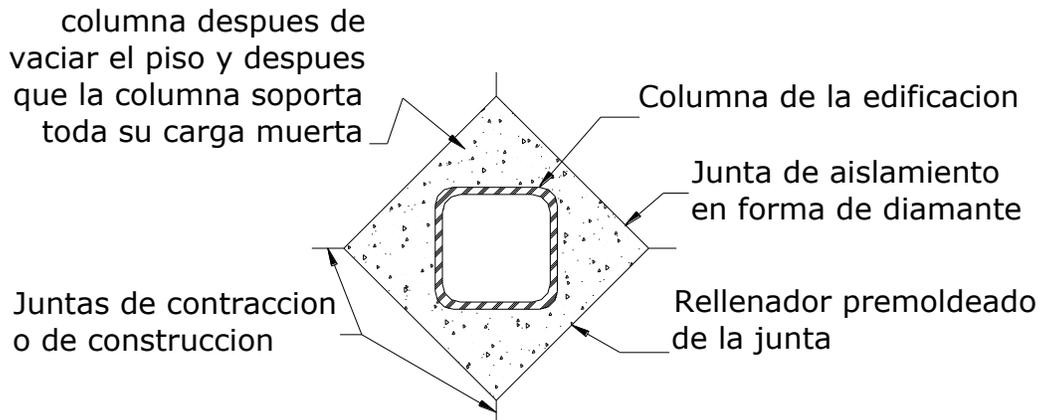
b - Junta de aislamiento en columnas (vista de planta) de la junta
